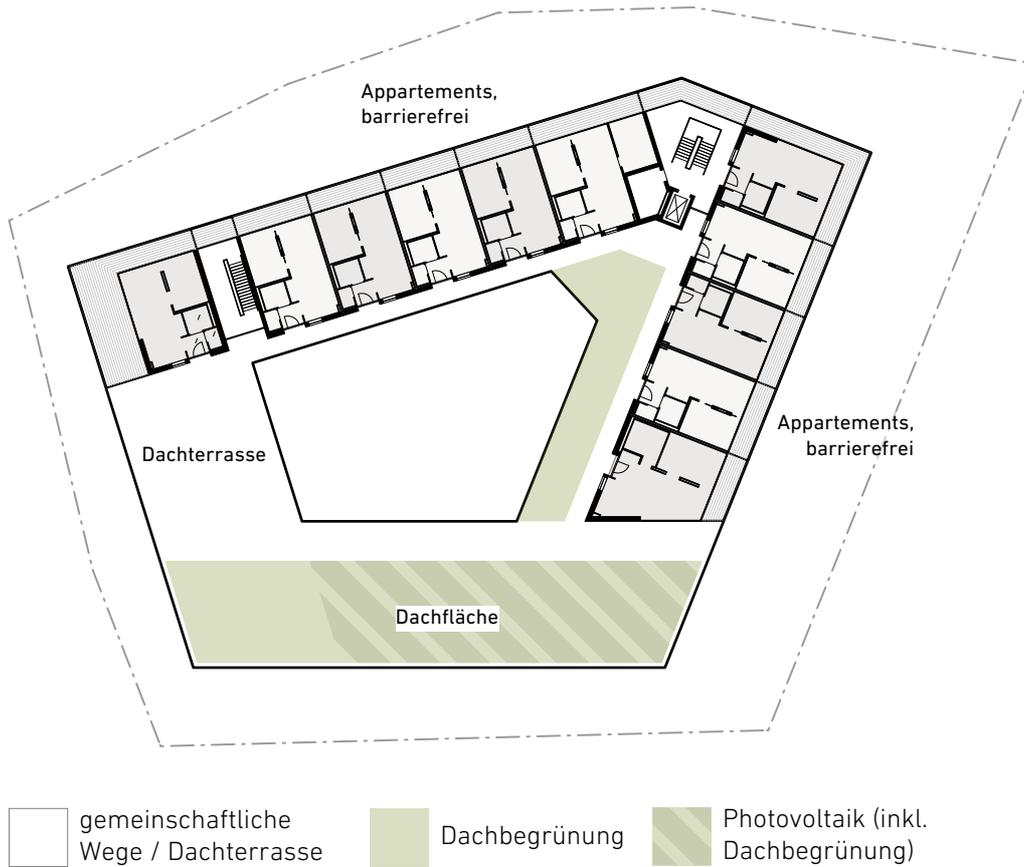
Das Vorhaben - Grundriss 4.Obergeschoss (Vorentwurf)
